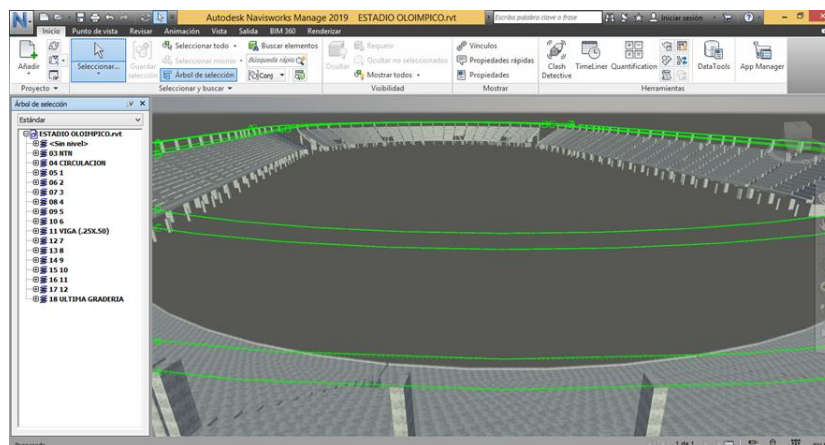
Modelado de estructura de Tribuna Norte (Estructura Gris)
